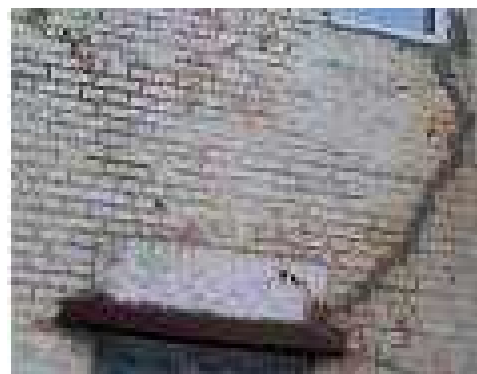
Фрагмент стіни будівлі з тріщиною / Detail of the building wall with a crack
